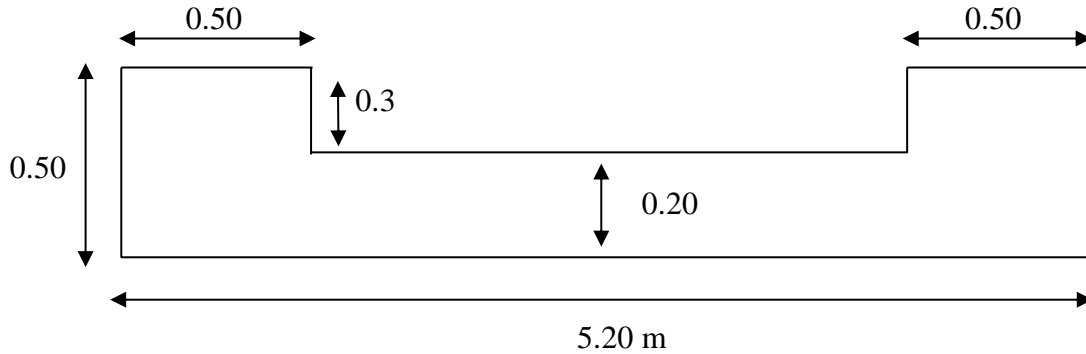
Voile plein de forme rectangulaire avec deux poteaux.
